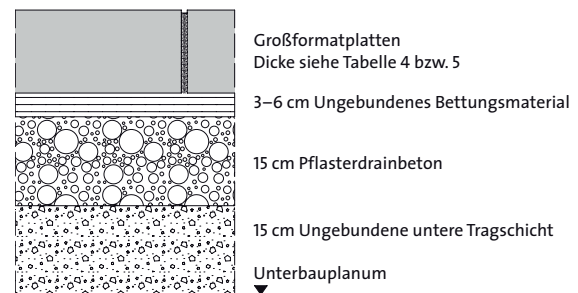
Standardaufbau für Großformatplatten in ungebundener Bauweise mit Pflasterdrainbeton-tragschicht, Lastklasse LKo,1 bzw. LKo,05, Bautype PF8
